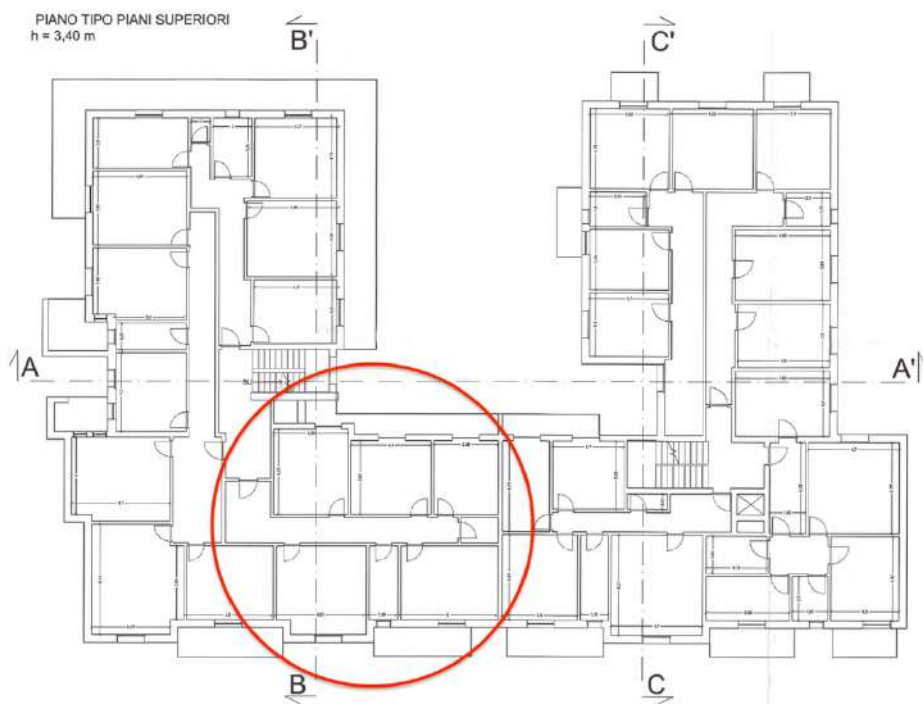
Pianta del Piano Tipo del fabbricato estratta dalla S.C.I.A. prot. 07754/2021 (cfr. All. 7c3)
